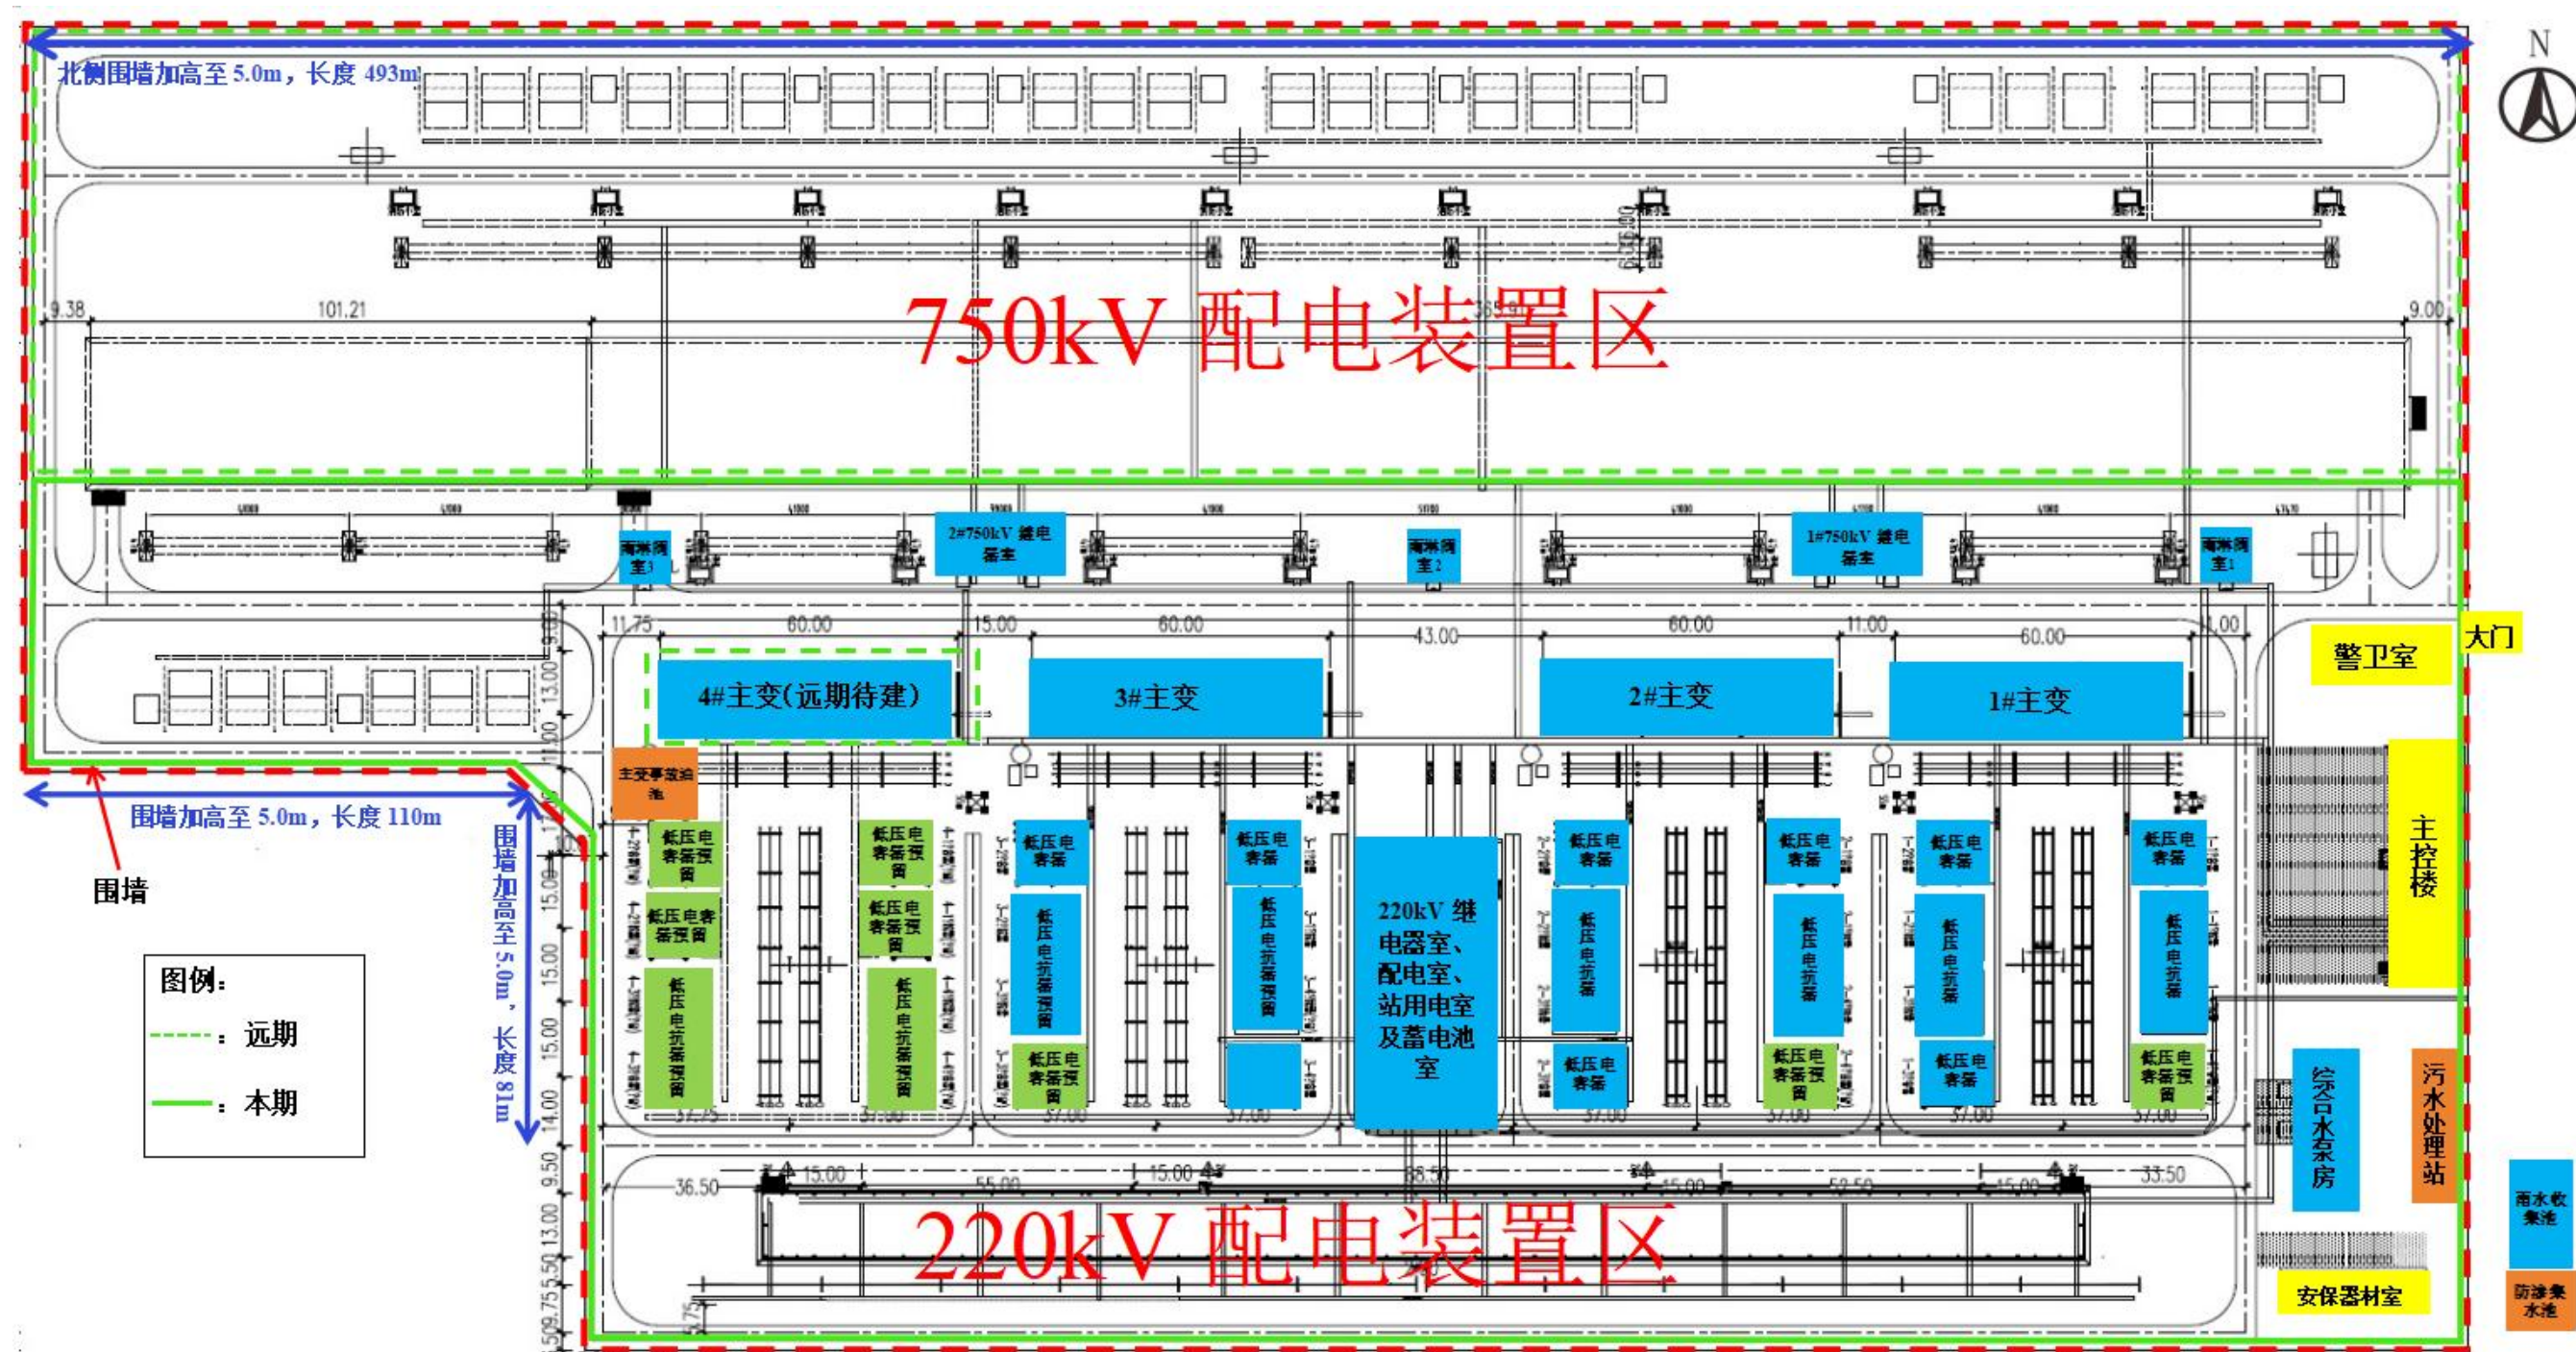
库尔勒西 750kV 变电站平面布置图
